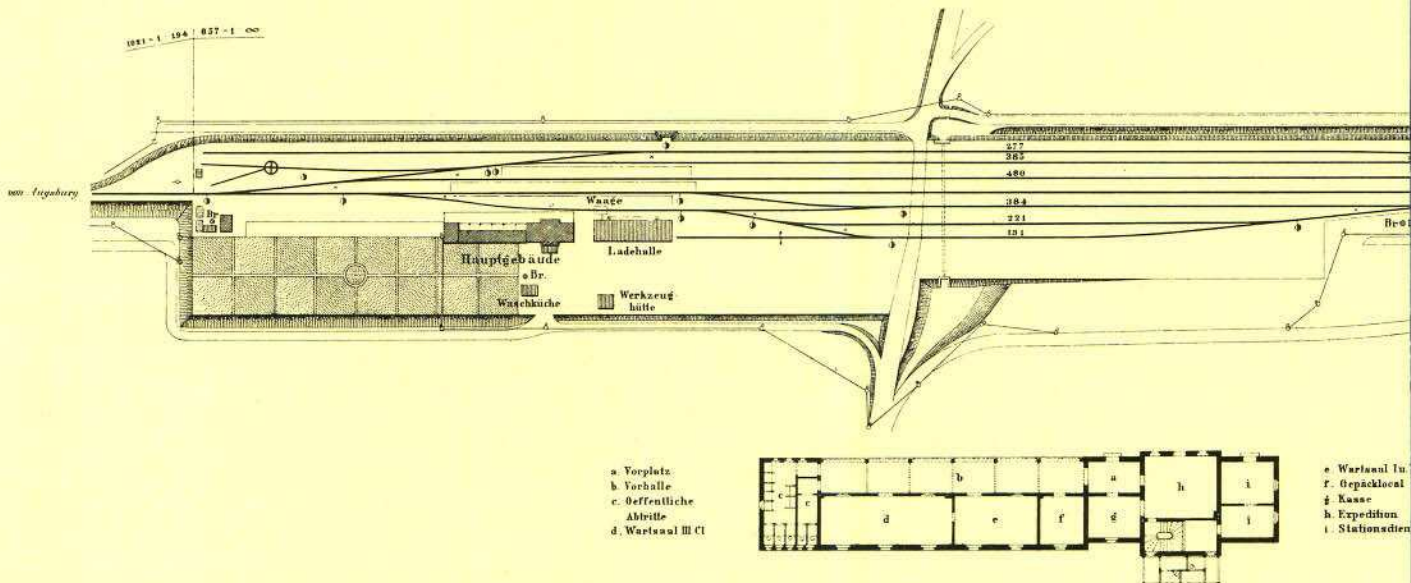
(oben): Bescheidener als Inningen konnte eine Station an einer eingleisigen Hauptbahn damals kaum aussehen: Hauptgleis mit Ausweichgleis, Anschlußgleis zur Ladehalle und Stumpfgleis mit Waage.
